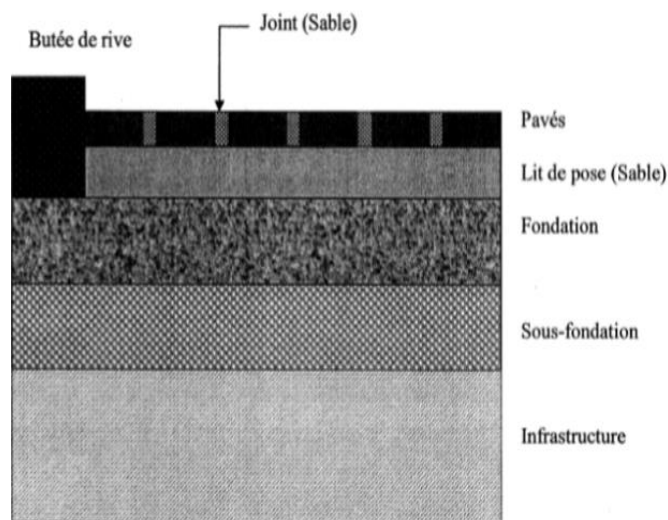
coupe schématique d'une chaussée revêtue pavées [17]
